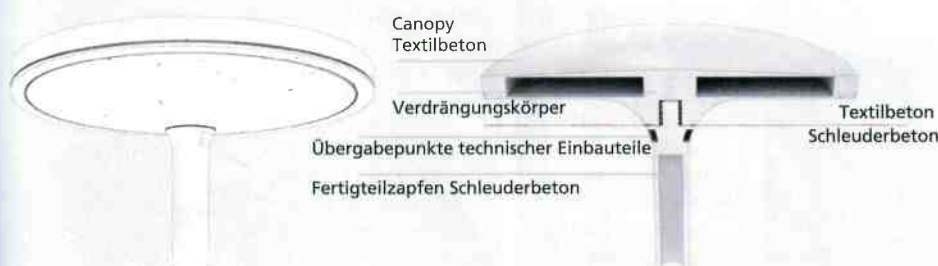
Prinzipdarstellung – Hybride Stützenkopfkonstruktion für die SAB Leipzig aus textil- und stahlbewehrtem Beton
